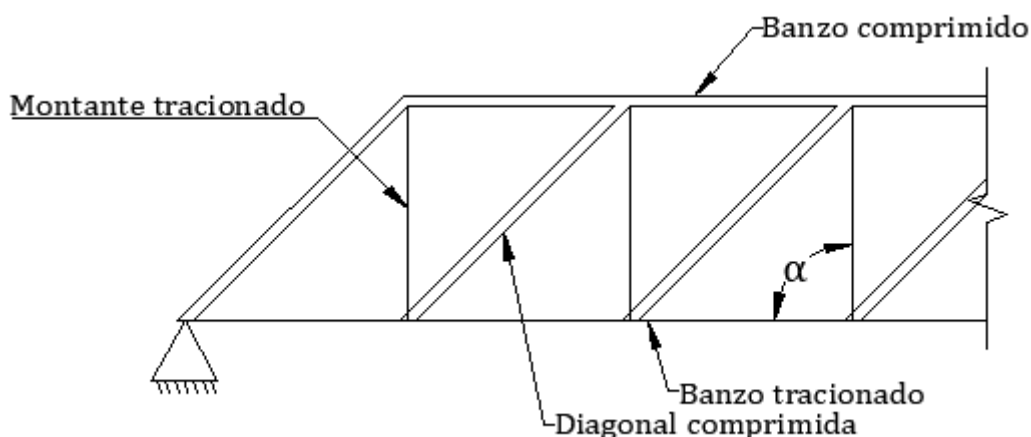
Treliça análoga de Morsch para o caso de viga biapoada armada com estribos verticais (Fonte: autor).
